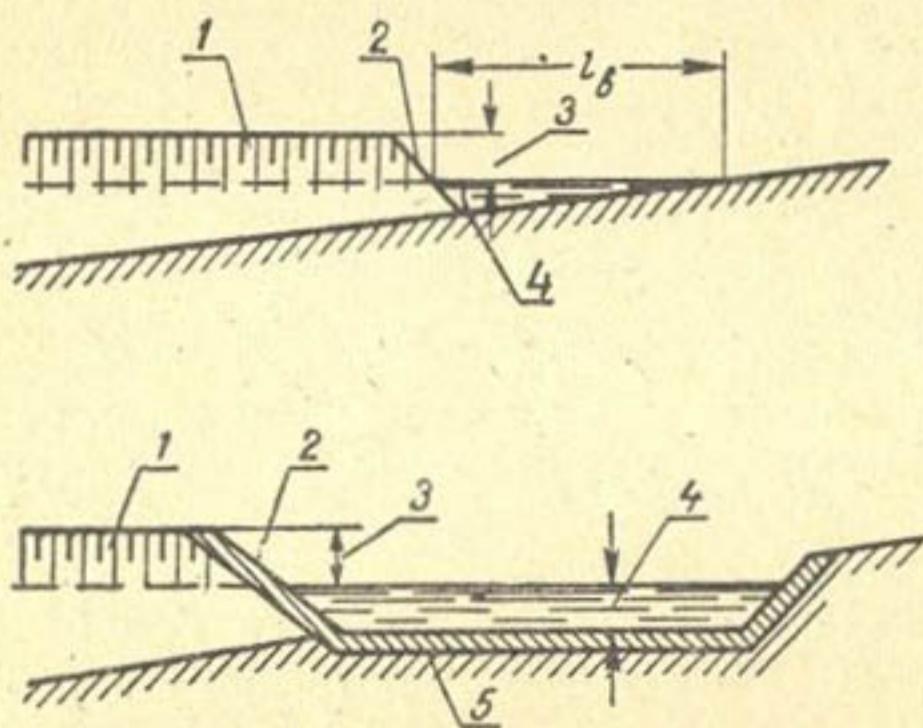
Водообход у шпоры для пропуска воды (вверху — треугольного сечения без крепления; внизу — трапециoidalного сечения с креплением):
